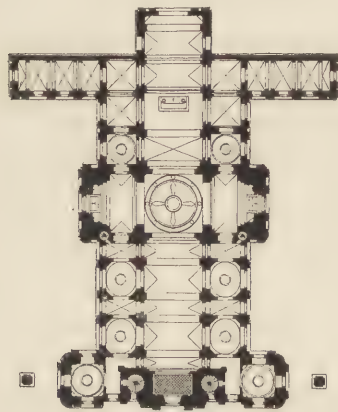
Dom zu Fulda. Grundriss.
